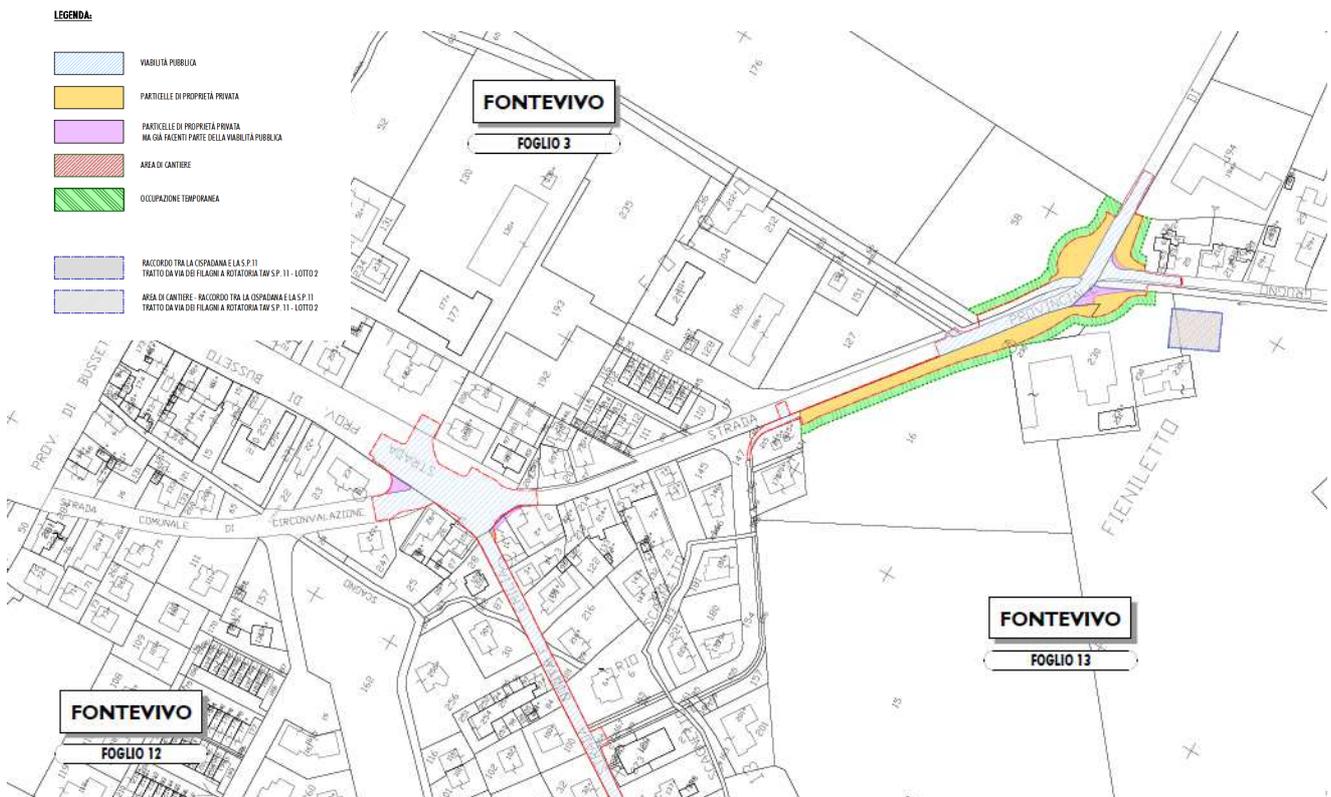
PLANIMETRIA CATASTALE CON INDIVIDUAZIONE DELLE PARTICELLE INTERESSATE DALL'ESECUZIONE DELLE OPERE
